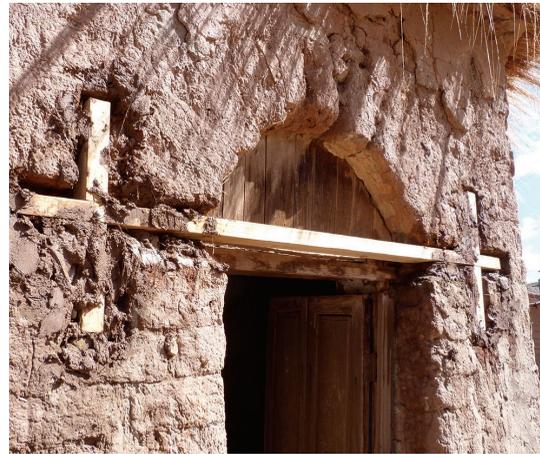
Colocación de llaves de madera en arcos. Fuente: Fotografía de las autoras.
